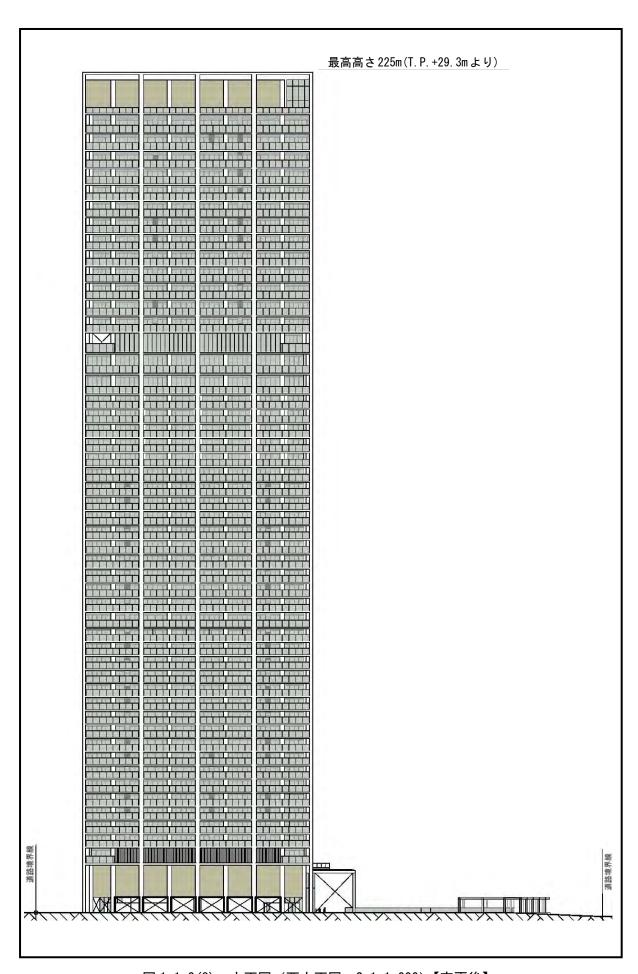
(8) 立面図 (西立面図 S=1:1,000)【変更後】
